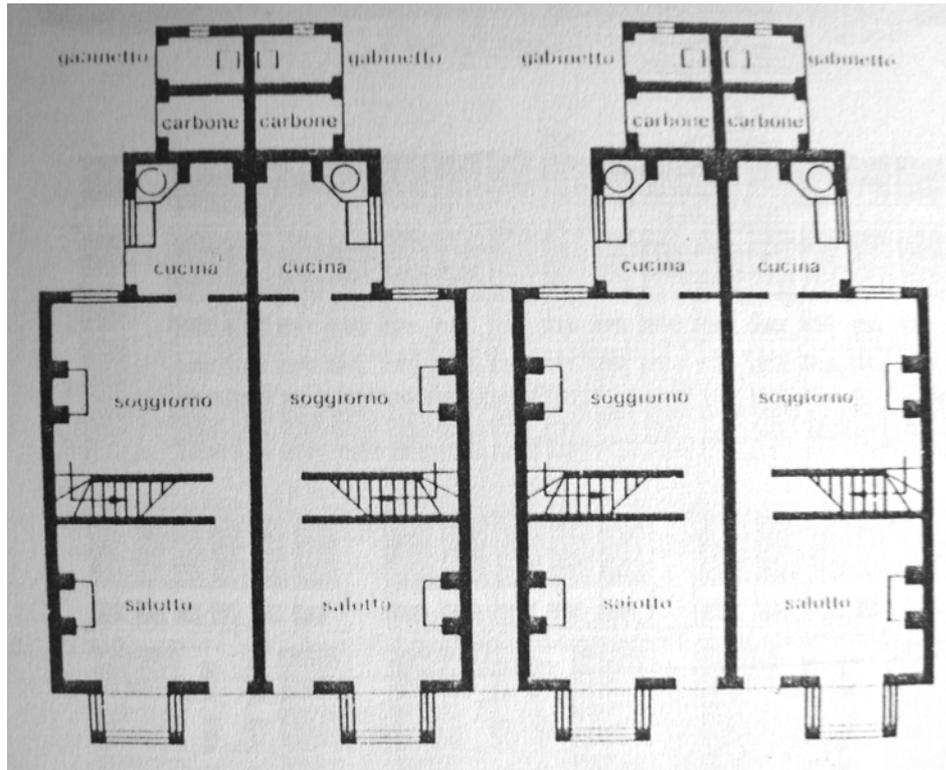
Plantas baixas do primeiro pavimento de casas em fileira inglesa, conforme os regulamentos de 1875
